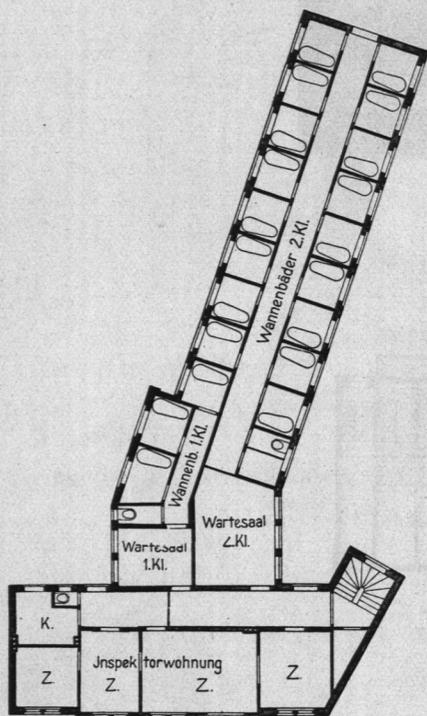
Badeanstalt Sternstraße, erstes Obergeschoß.
